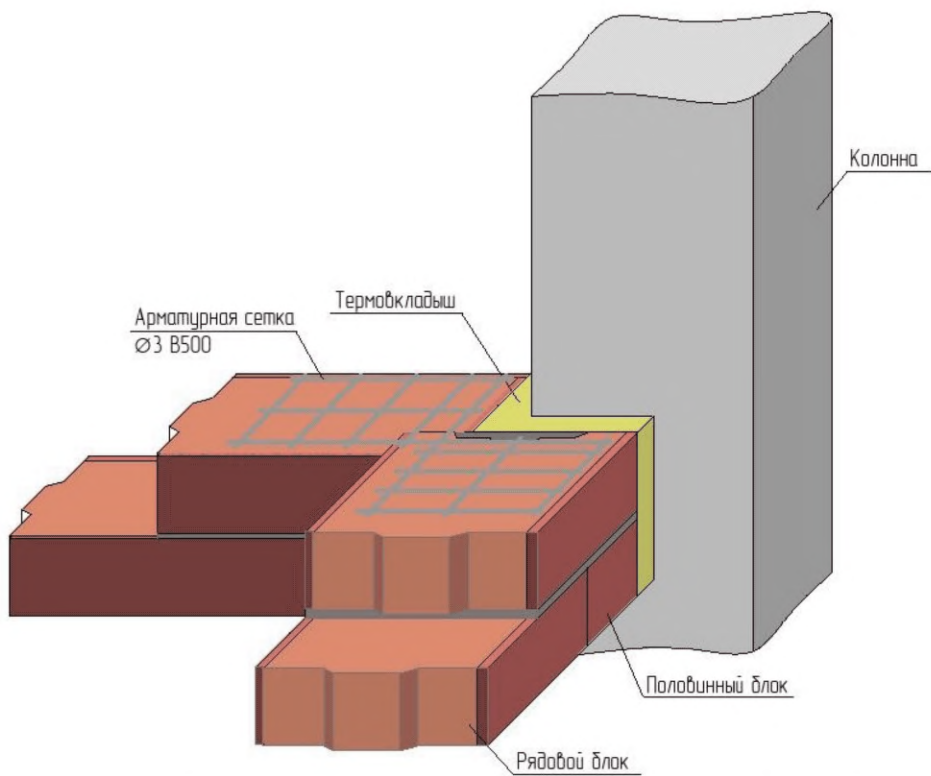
Пример сопряжения стены с железобетонной колонной (Вариант 3)
